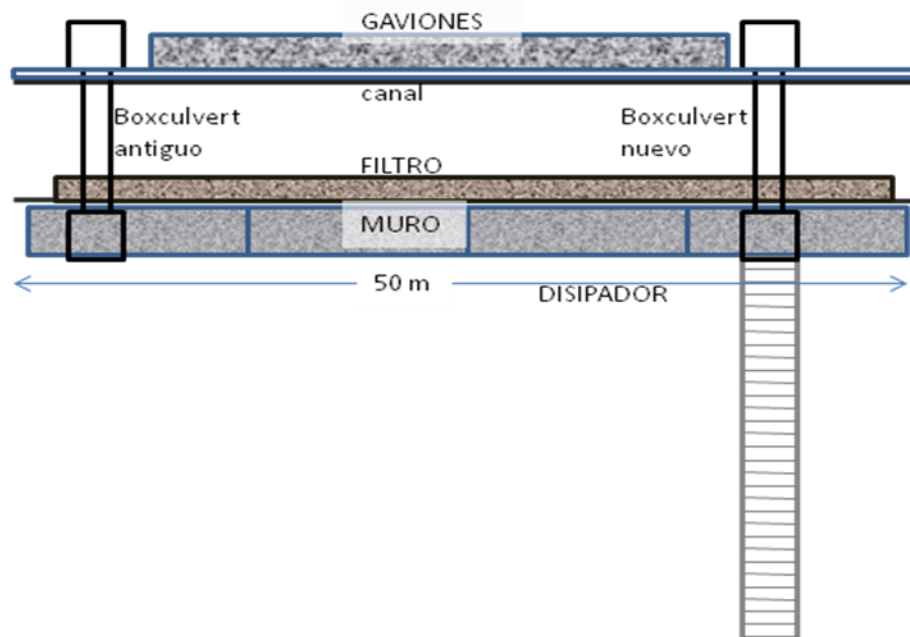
Planta de las obras ejecutadas en el PR 91+0500
